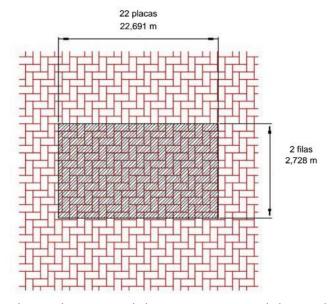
Vista en planta y dimensiones de la estructura soporte de los paneles solares.
